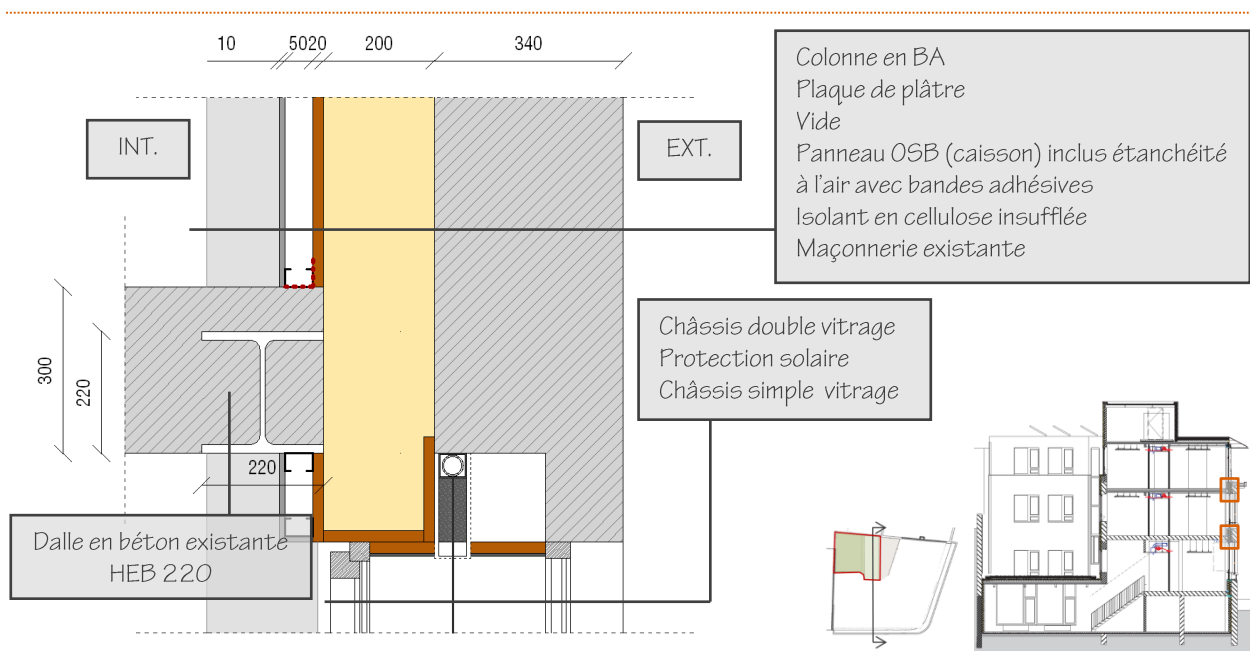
Détail de l'isolation par l'intérieur de la façade avant au droit du plancher du 1<sup>er</sup> étage, mesures en [mm]
